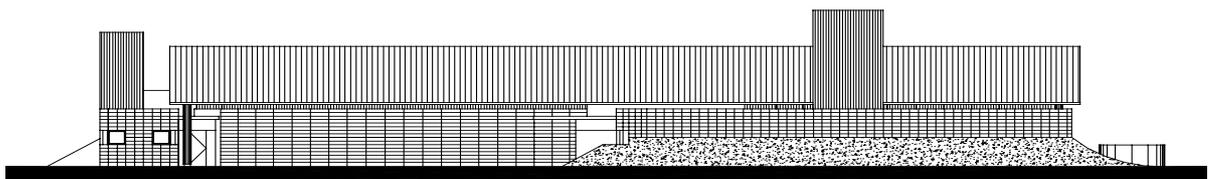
Vista sur: cubierta chapa trapezoidal, muro de bloques de hormigón, taludes protectores
